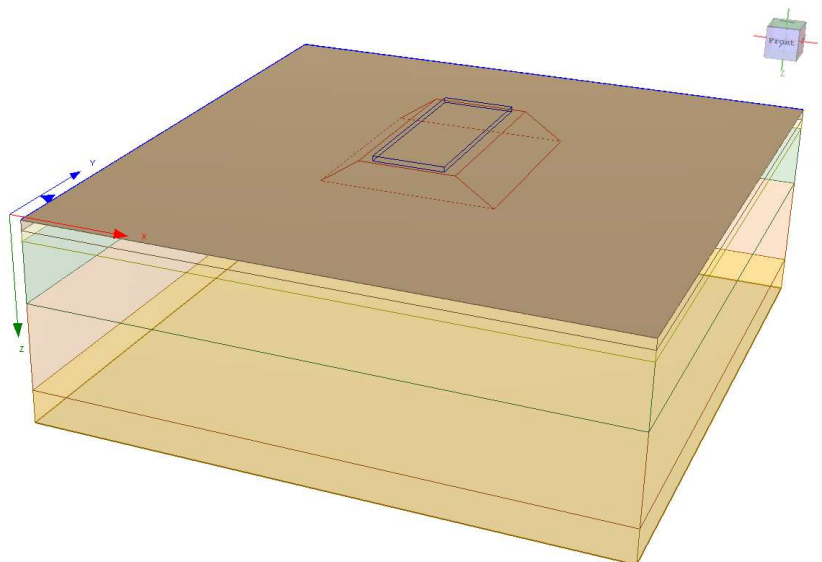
Rilevato sez n° 12 alla pk 26+800 - Analisi SLE – Modello di calcolo – Posa Ballast
